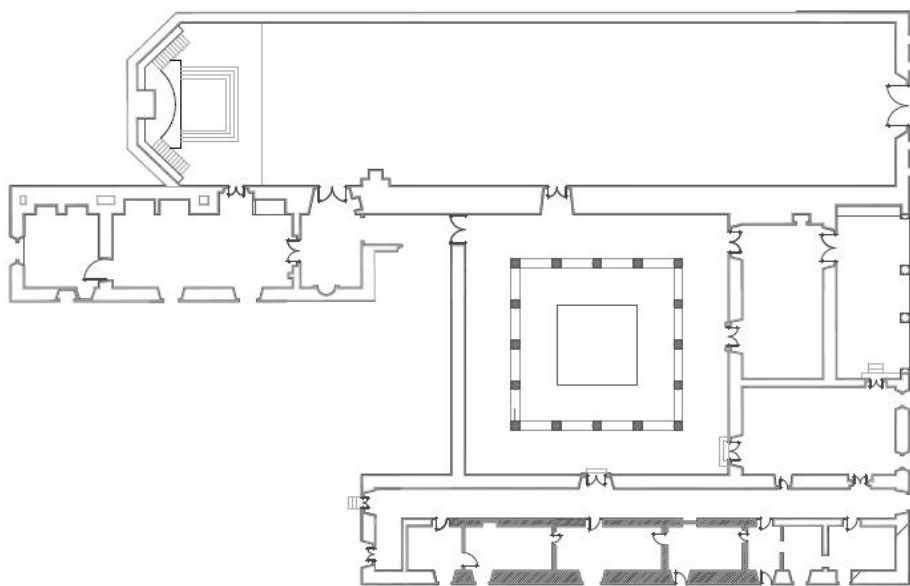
Planta arquitectónica, etapa constructiva 1578-1610⁵⁵
